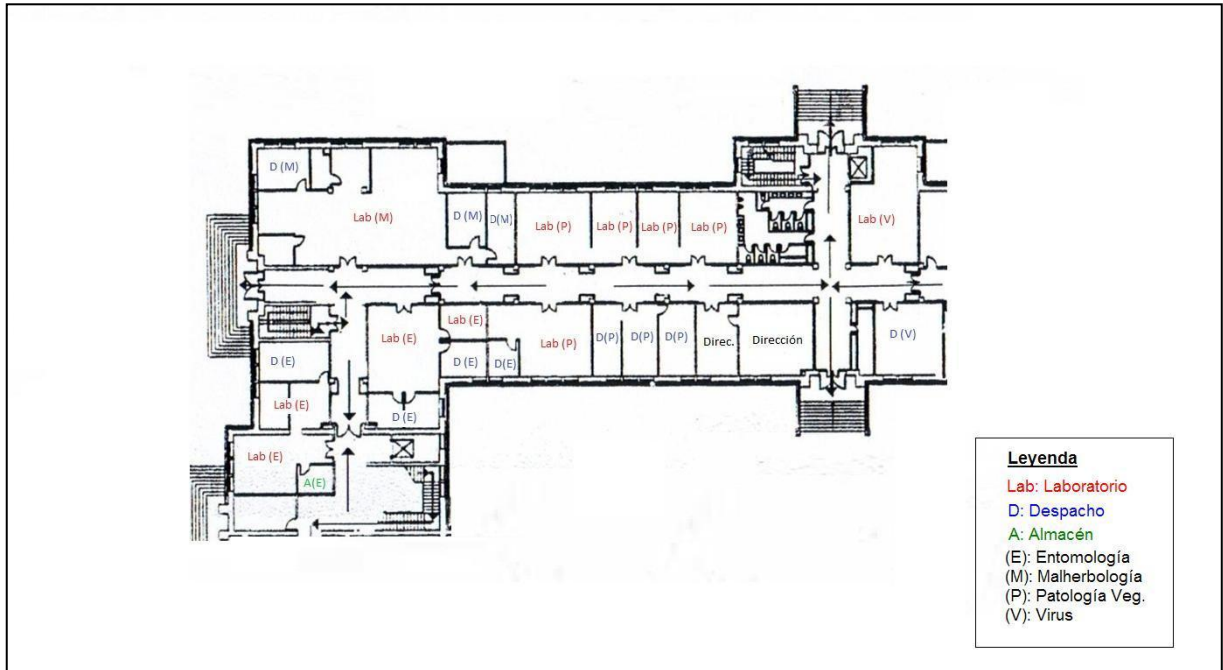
Plano de la planta semisótano del Dep. de Protección vegetal.
